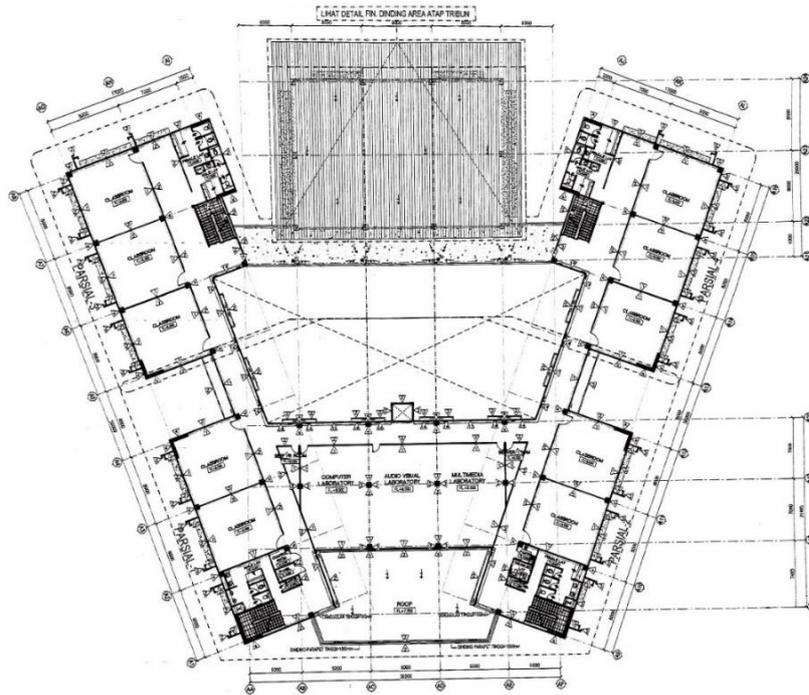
Parsial-3 Denah rencana *finishing* dinding lantai 1
